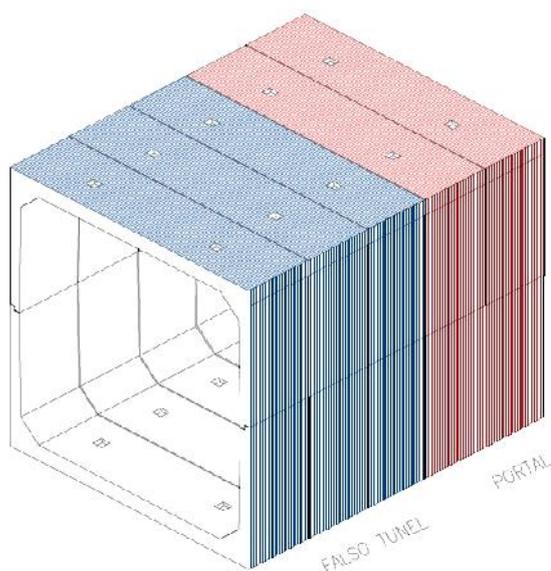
Vista isométrica de falso túnel y portal de concreto armado prefabricado
